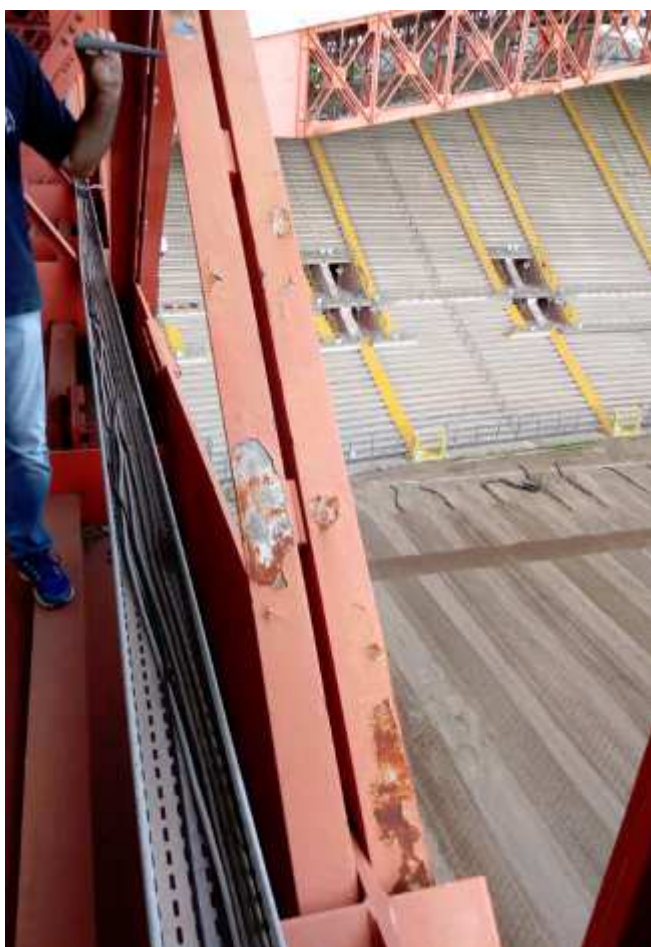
e 20: degrado tipo riscontrato sugli elementi metallici delle aste di parete travi rosse
